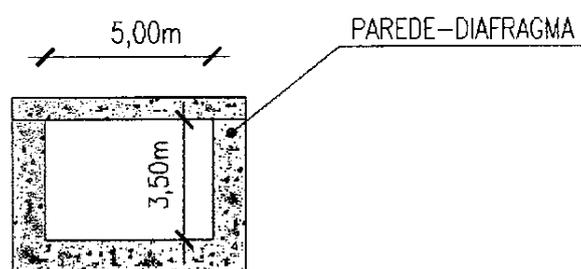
Esquema construtivo do trecho 2 do córrego Cachoeirinha.
